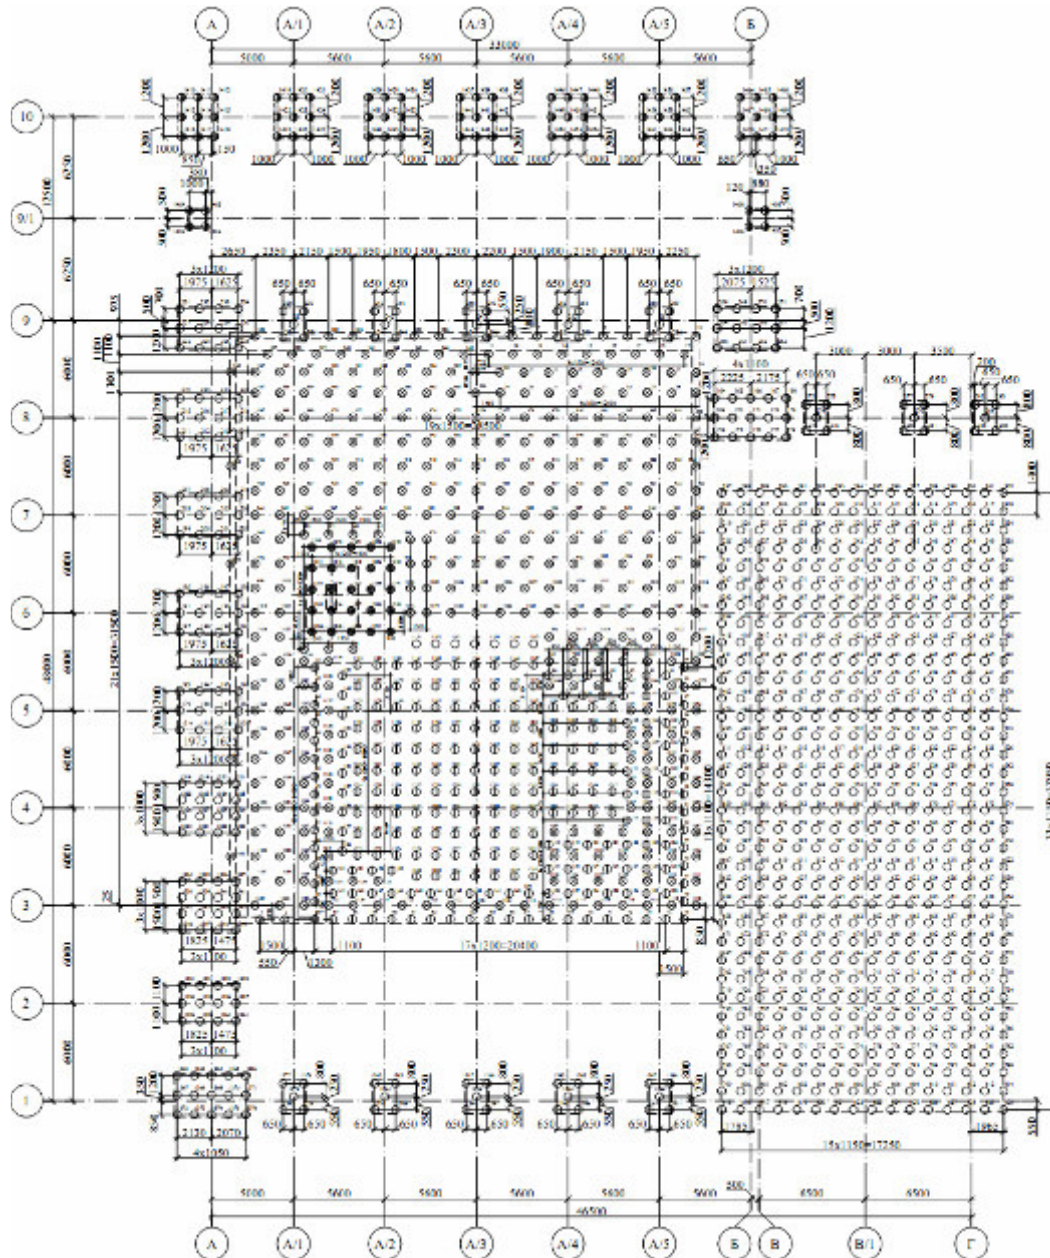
Схема расположения грунтоцементных армирующих элементов
